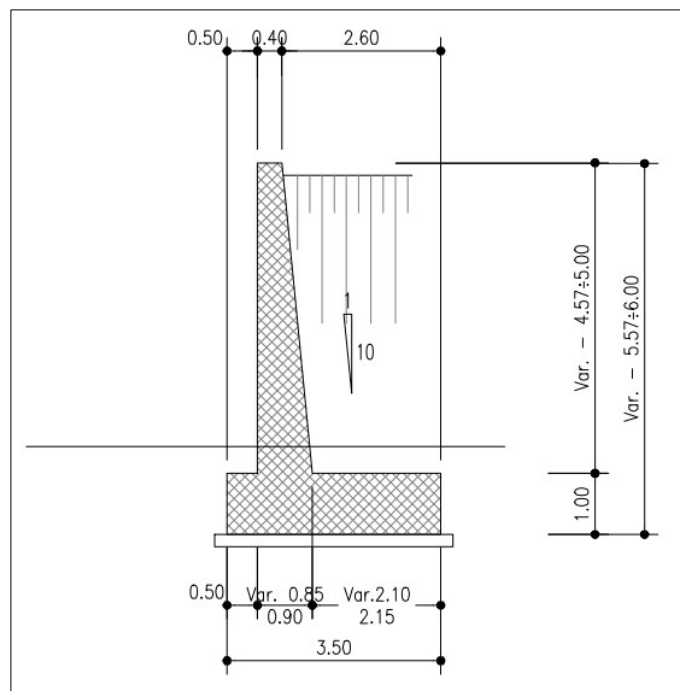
Sezione trasversale del muro d'ala – Lato Nord
